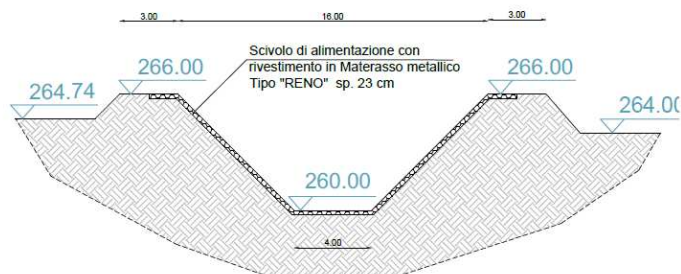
Sezione Scivolo di alimentazione con rivestimento in materasso tipo "Reno"
